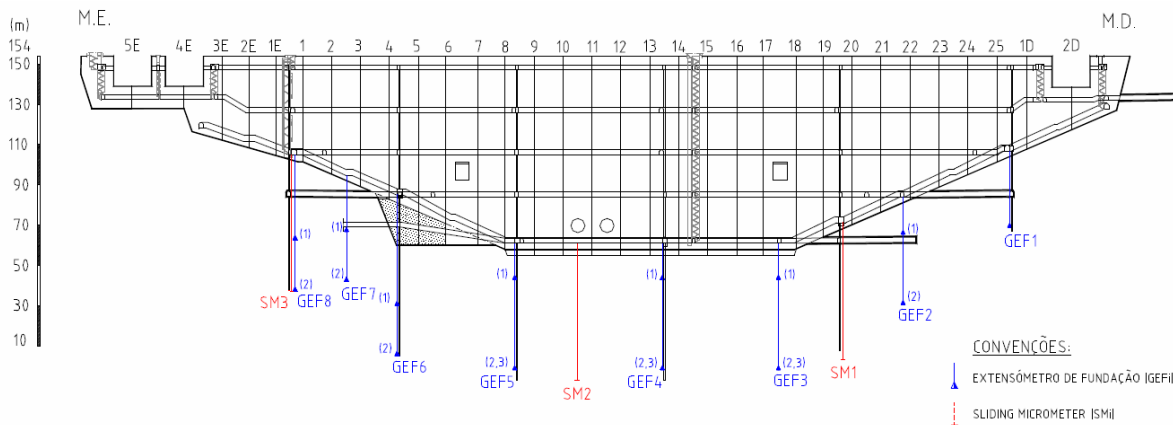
Sistema de extensómetros de fundação da barragem de Alqueva –
